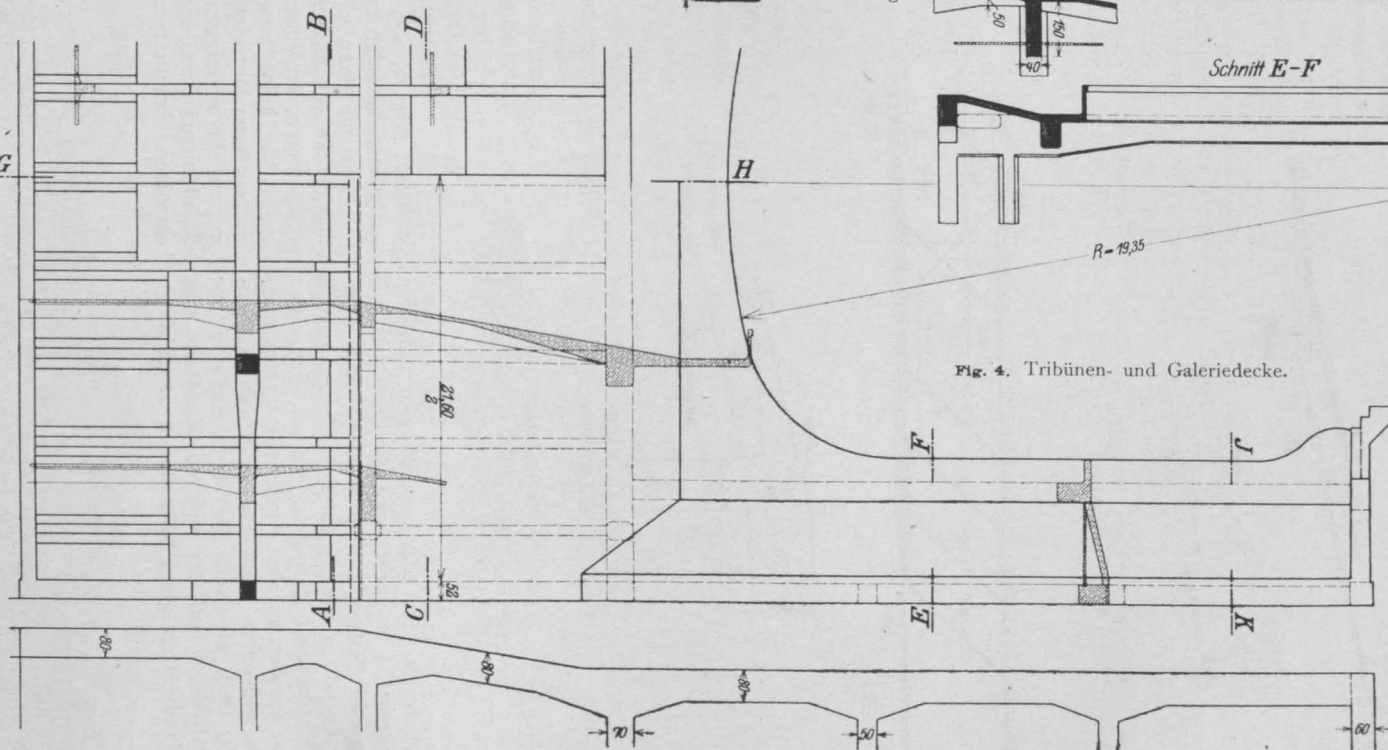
Grundriß der Tribünen- und Galeriedecke nebst zugehörigen Einzelschnitten.
